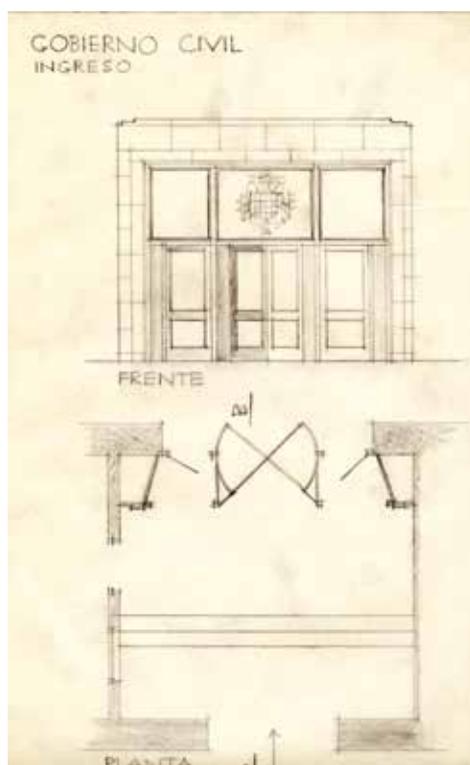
Planta y alzado del acceso principal al Gobierno Civil de Zaragoza, por el arquitecto José Borobio, enero de 1956 (Archivo BAU, Zaragoza).
